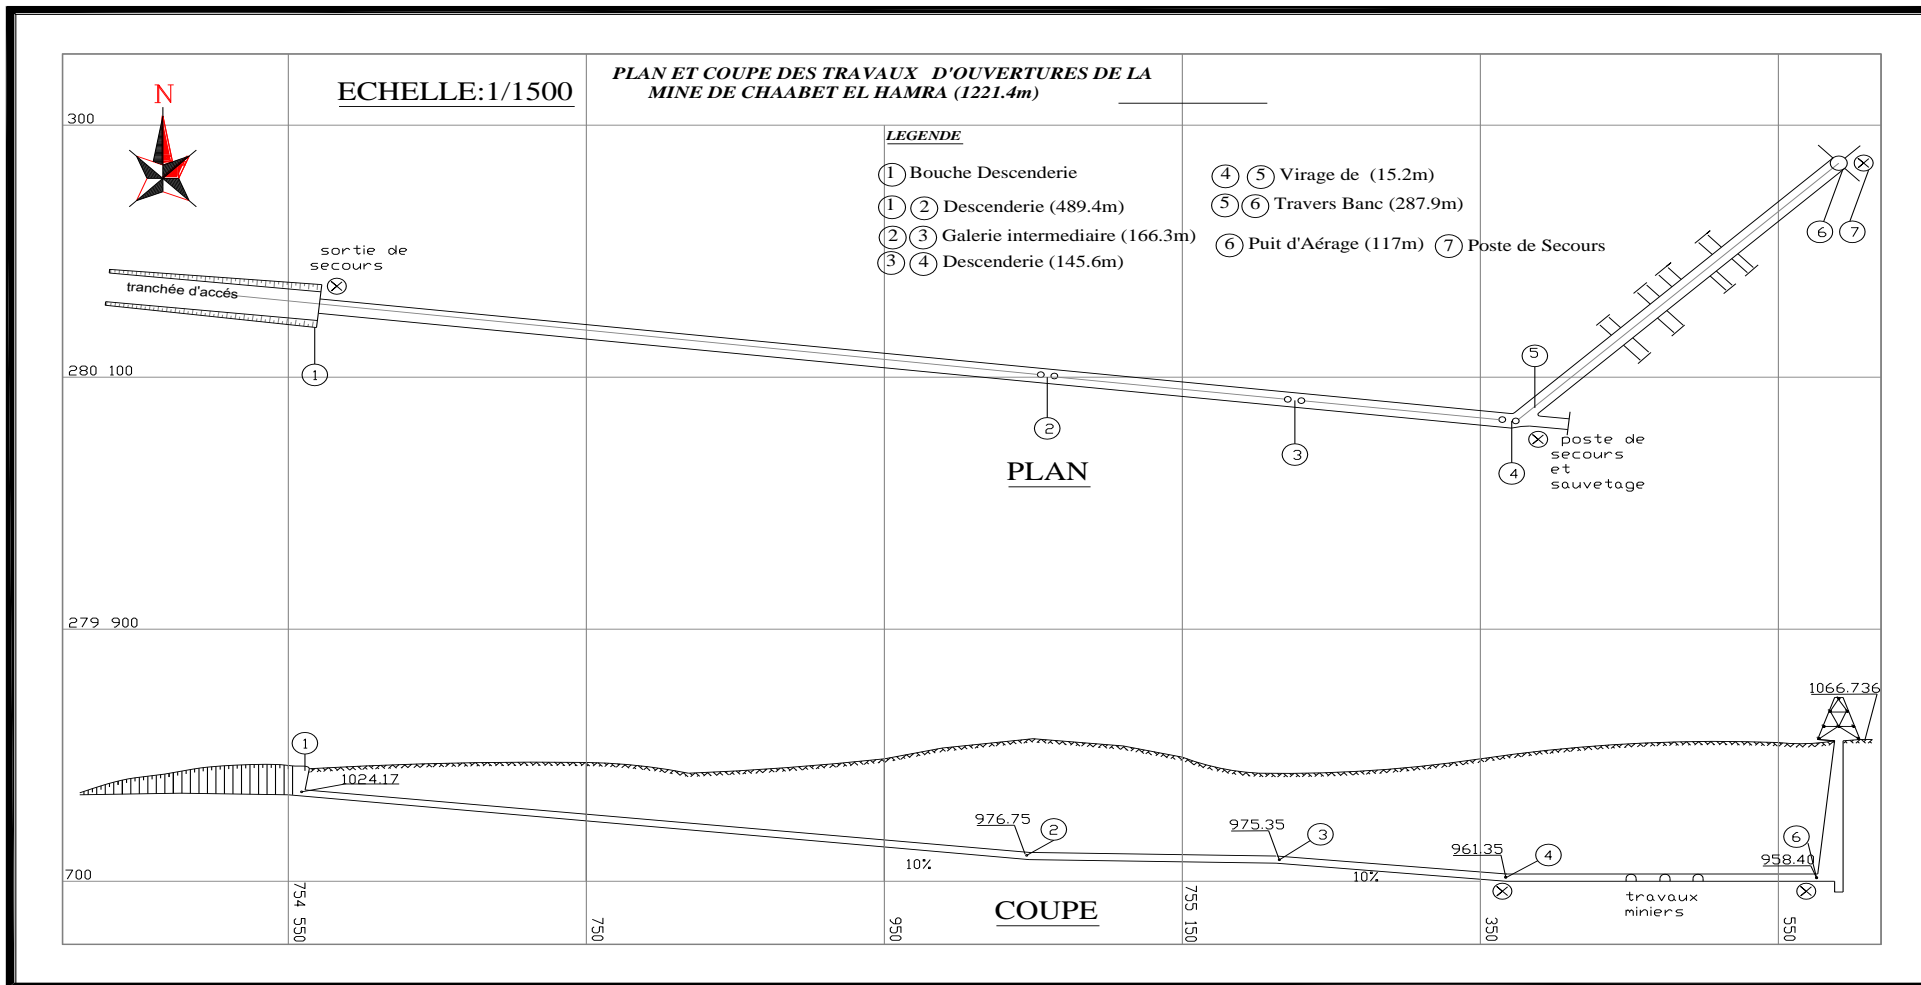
plan et coupe des travaux d'ouvertures de la mine de Chaabet El- Hamra
